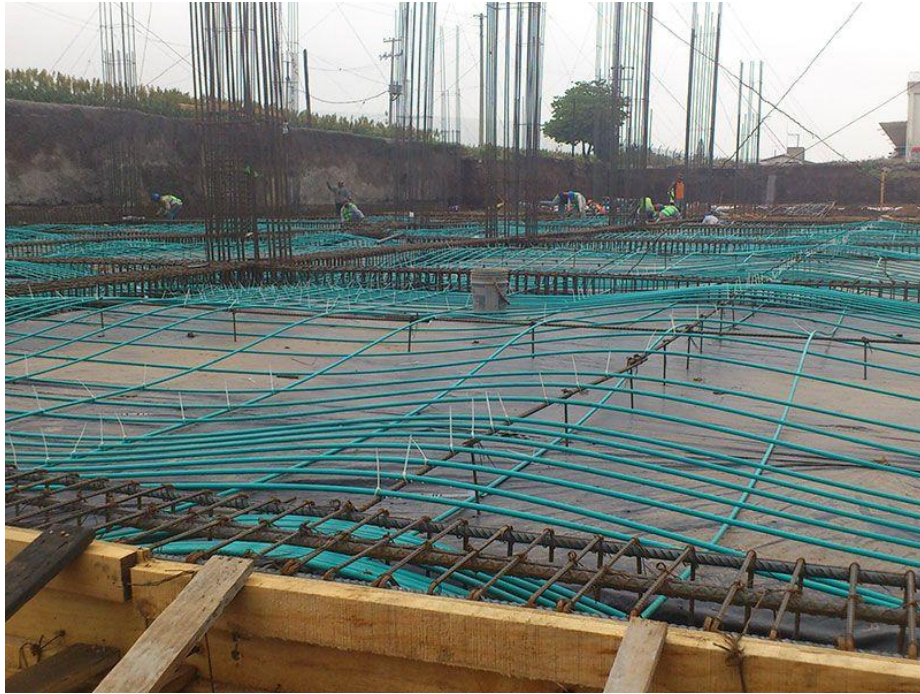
Construcción de losas en dos direcciones con cables no adheridos.
